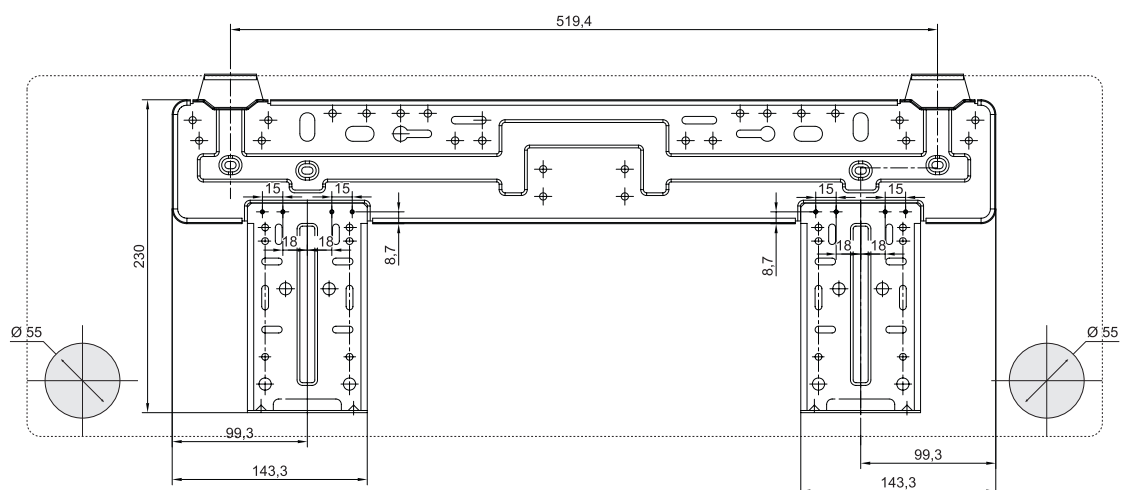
Placa de montaje para VAI 6-025 WMNI.
